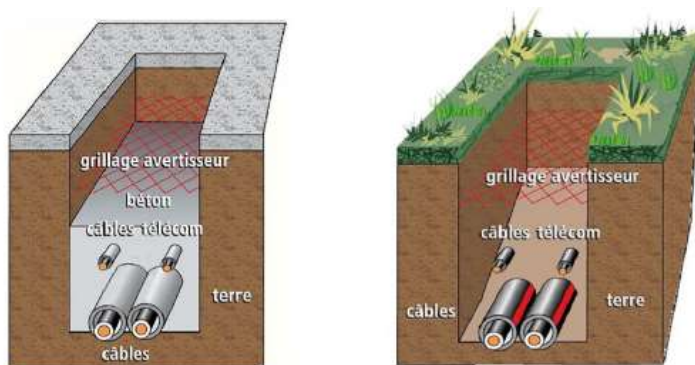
Représentation schématique de la pose en tranchée : PVC avec béton (à gauche) et PEHD pleine terre (à droite)
